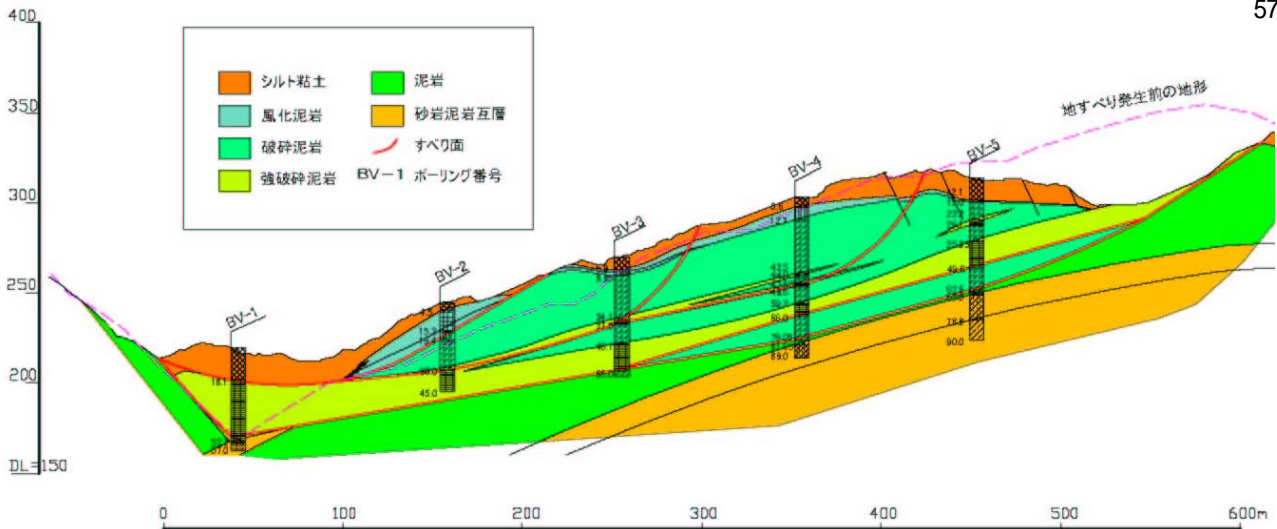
塩谷神沢川地すべり主測線地質縦断面図
